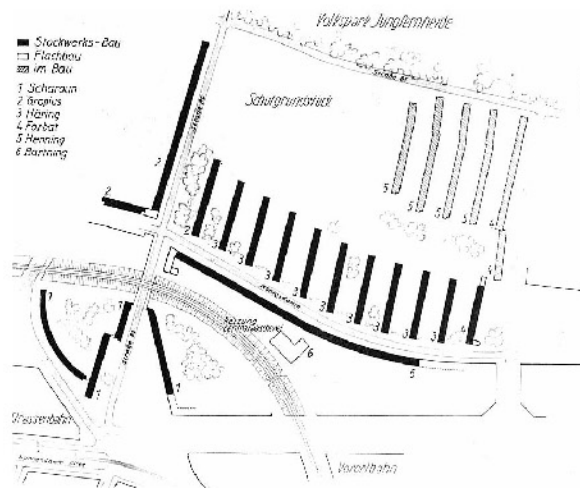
Planta general Siedlung Siemensstadt, 1929 - 1930
